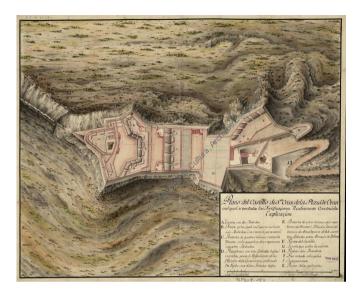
Planta del Castillo de Santa Cruz. Juan Ballester y Zafra, 1736
